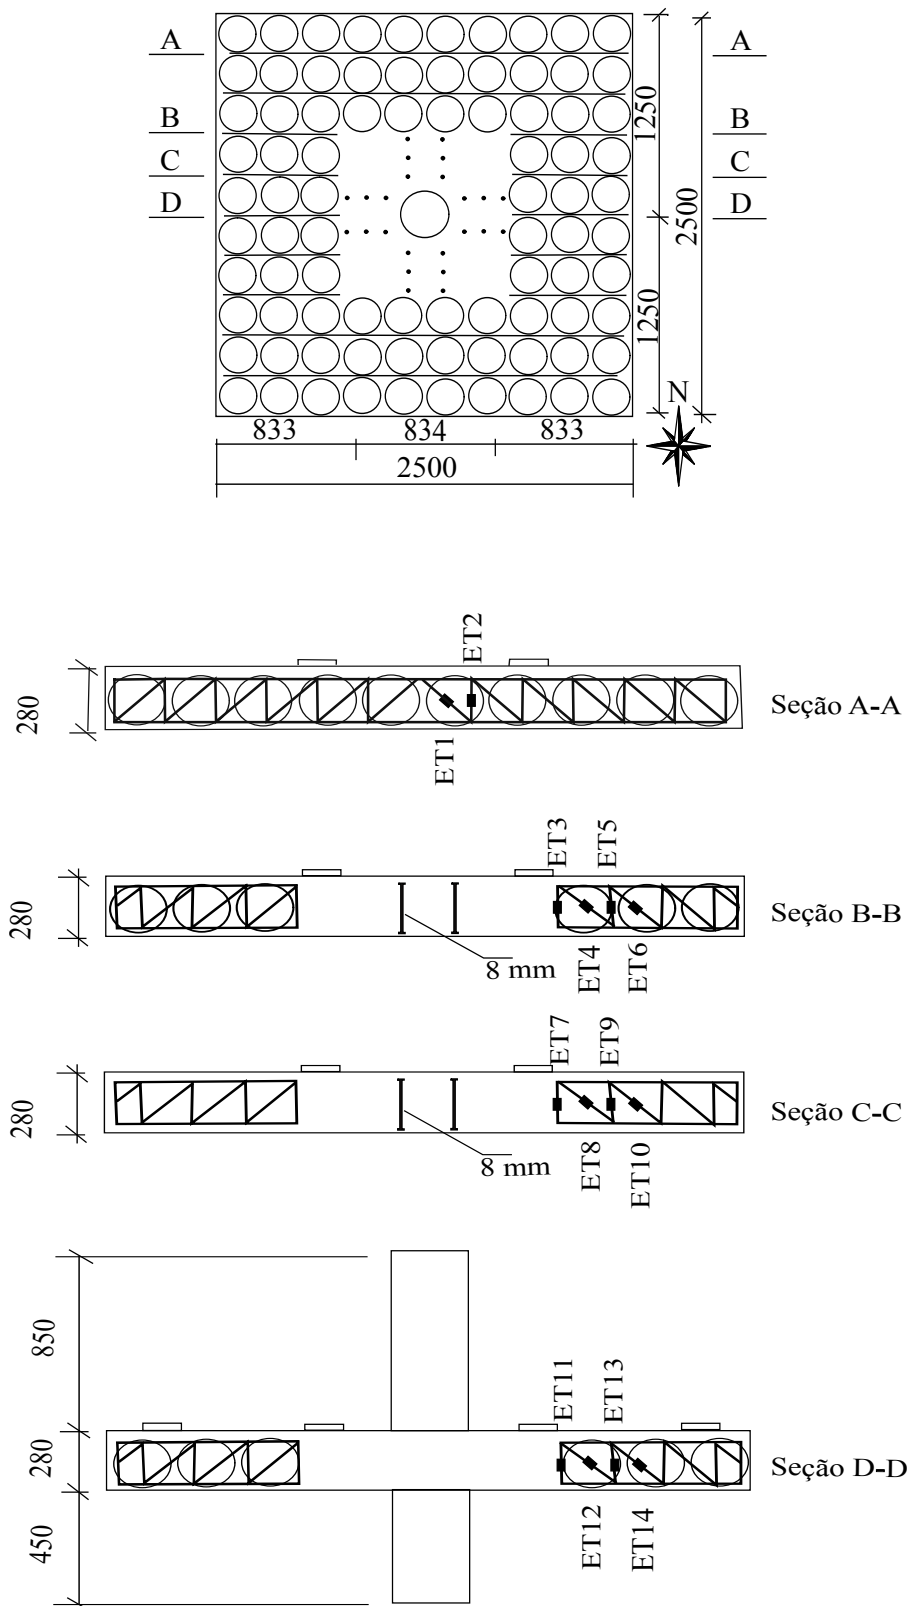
Posicionamento dos extensômetros nas treliças da laje BD-A03
